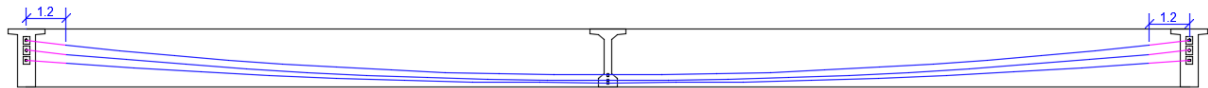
Tracé des câbles avec un alignement droit de 1,2 m à partir de l'encrage
